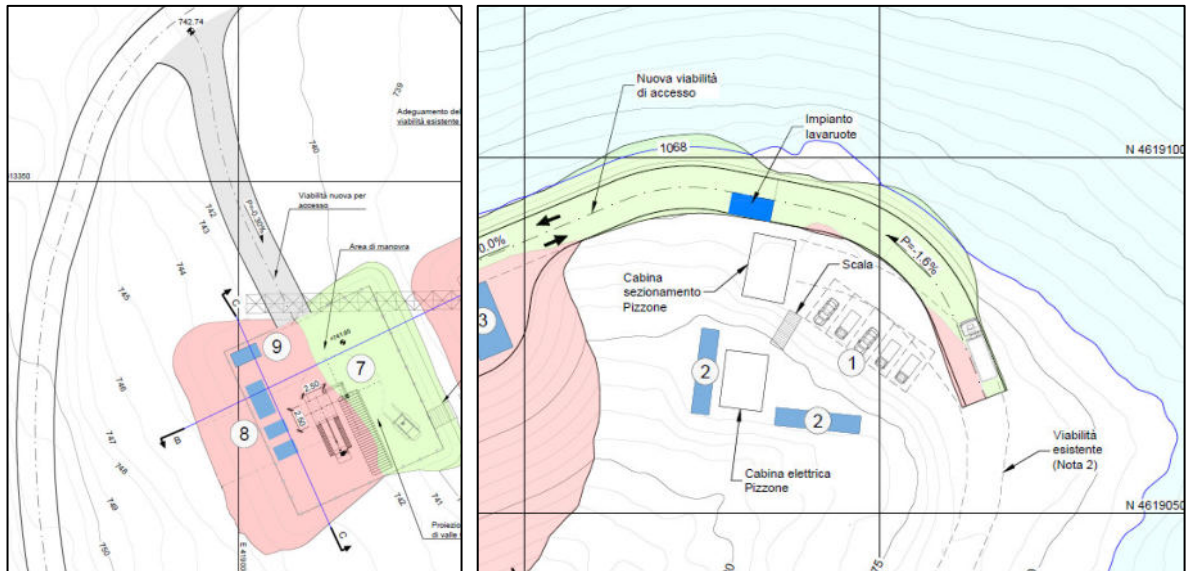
Ambito Pizzone – Viabilità di accesso al cantiere CA.GH4 – Pozzo piezometrico di valle (\*) – Ambito Alfedena – Accesso a cantiere CO.05 – Opera di presa di monte. (\*\*).
